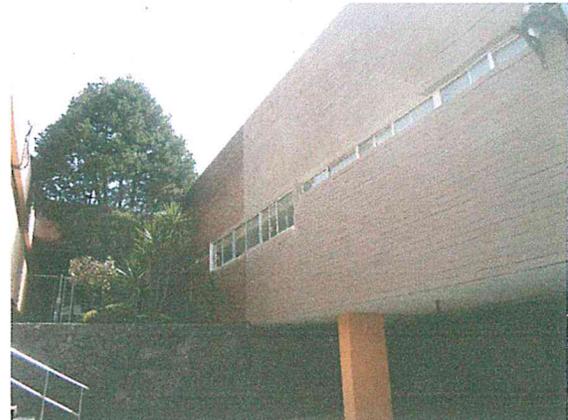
Fachada de uno de los cuerpos de crujías, sin afectación estructural.
